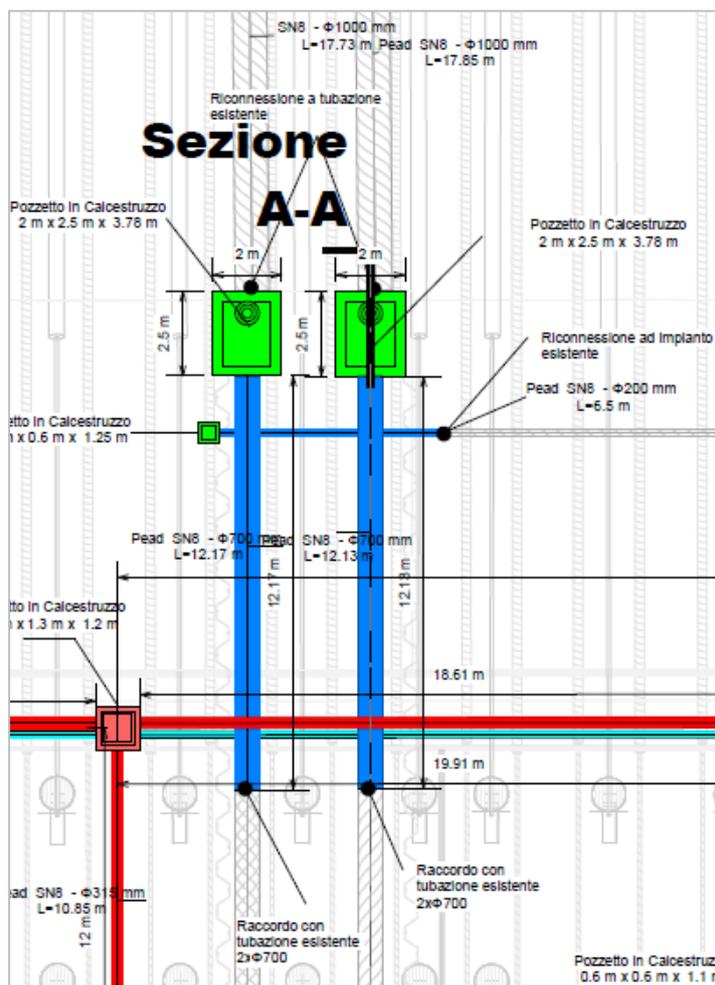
Vista planimetrica dei nuovi pozzetti d'ispezione e dei nuovi tratti di scarico a mare
